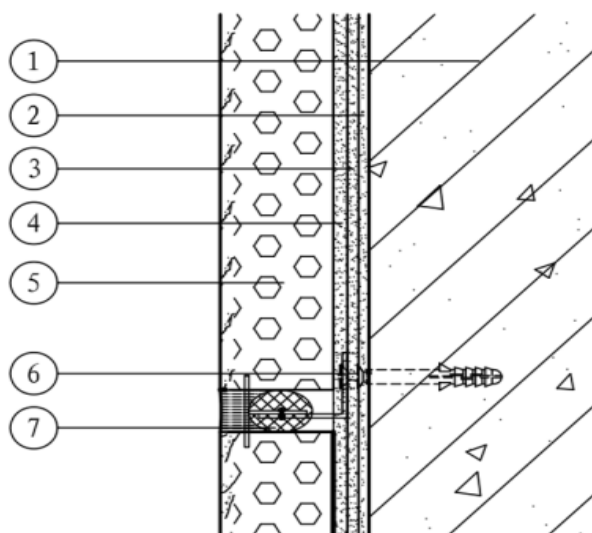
Система изоляции наружной стены фасадными пенокерамическими теплоизоляционными плитами OMNIFACTOR®
